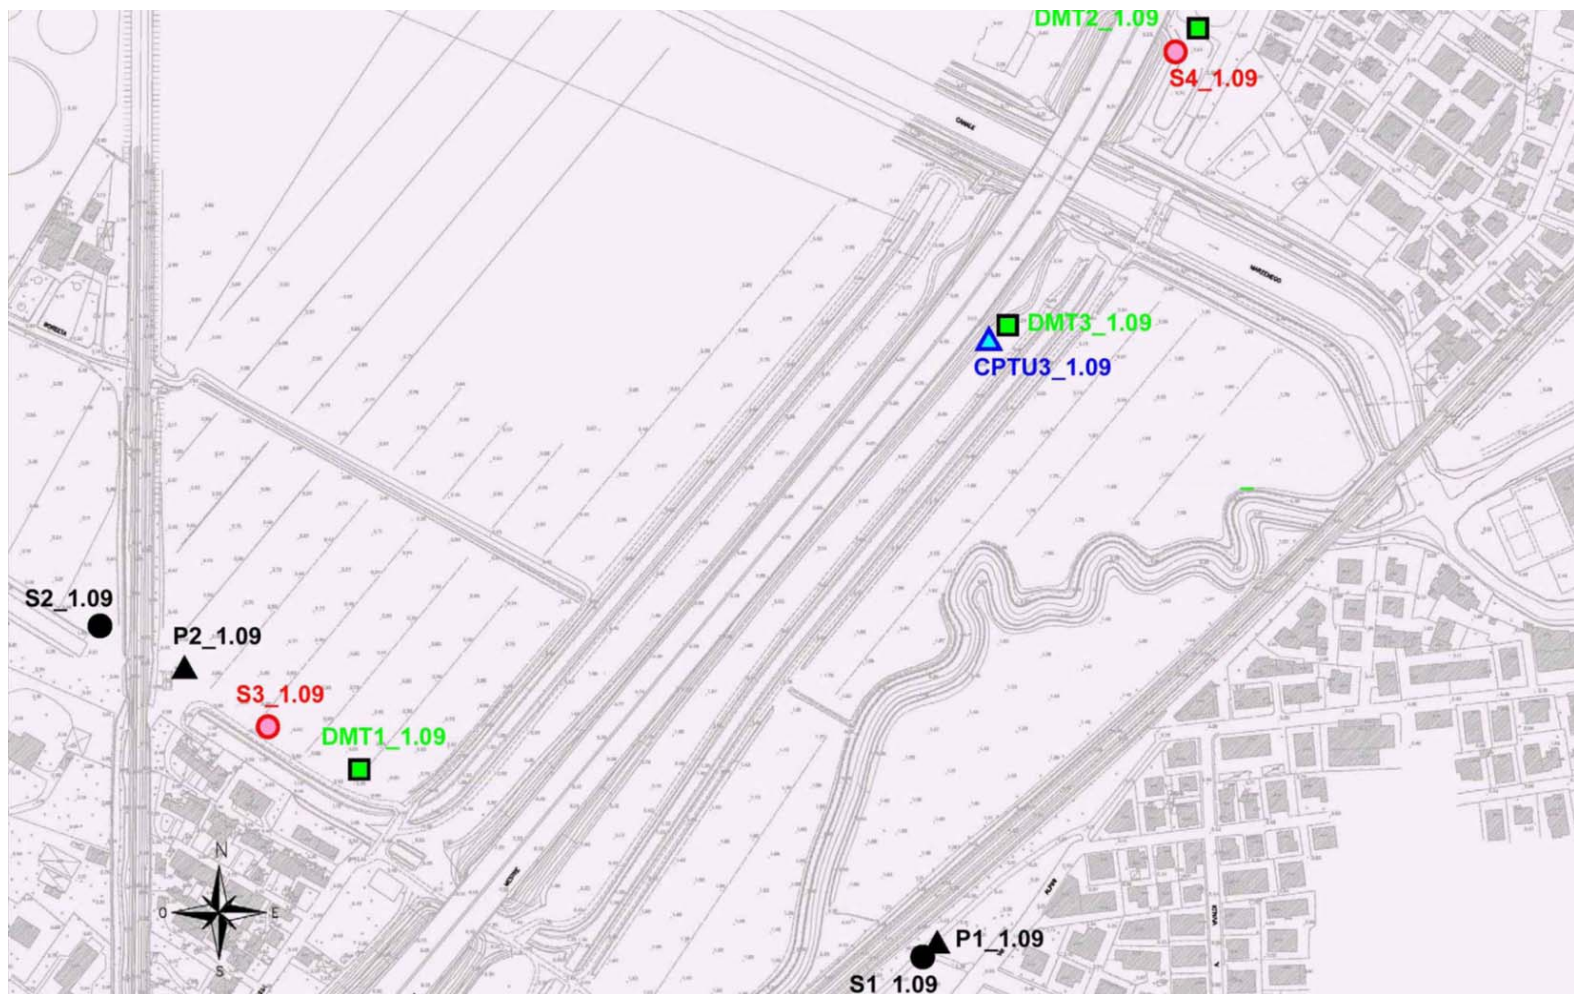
Planimetria con l'ubicazione delle indagini di repertorio.
